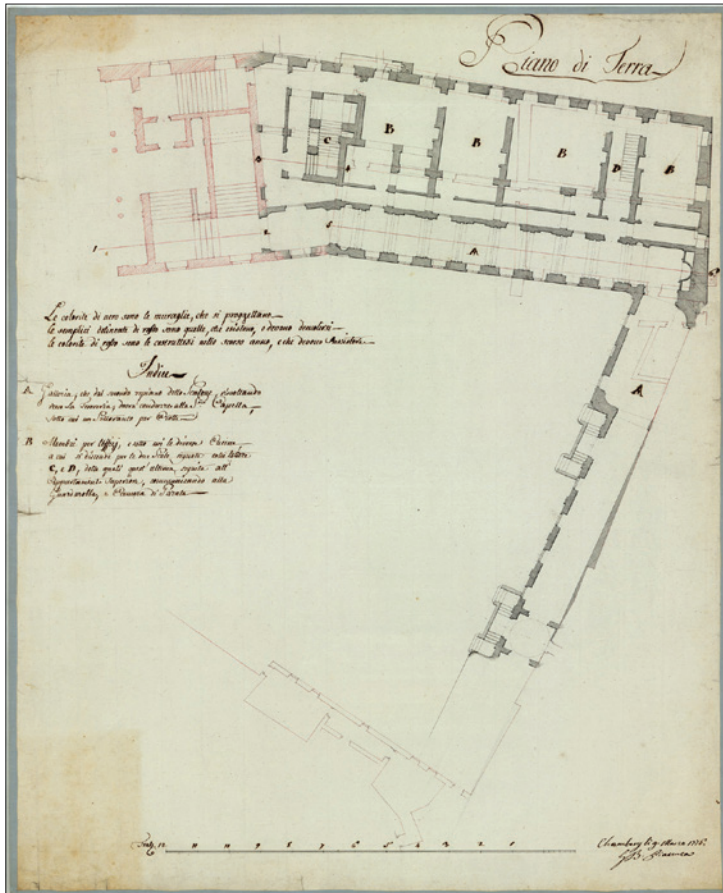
Projet d'aménagement du Vieux Pavillon, 1775, rez-de-chaussée ; le plan figure également en filigrane l'état des lieux de l'édifice (en lignes rouges) et l'état d'avancement de la construction de l'escalier d'honneur reliant les appartements royaux et le Vieux Pavillon. ASTO, Pallazi Reali, n. 014-002924.
